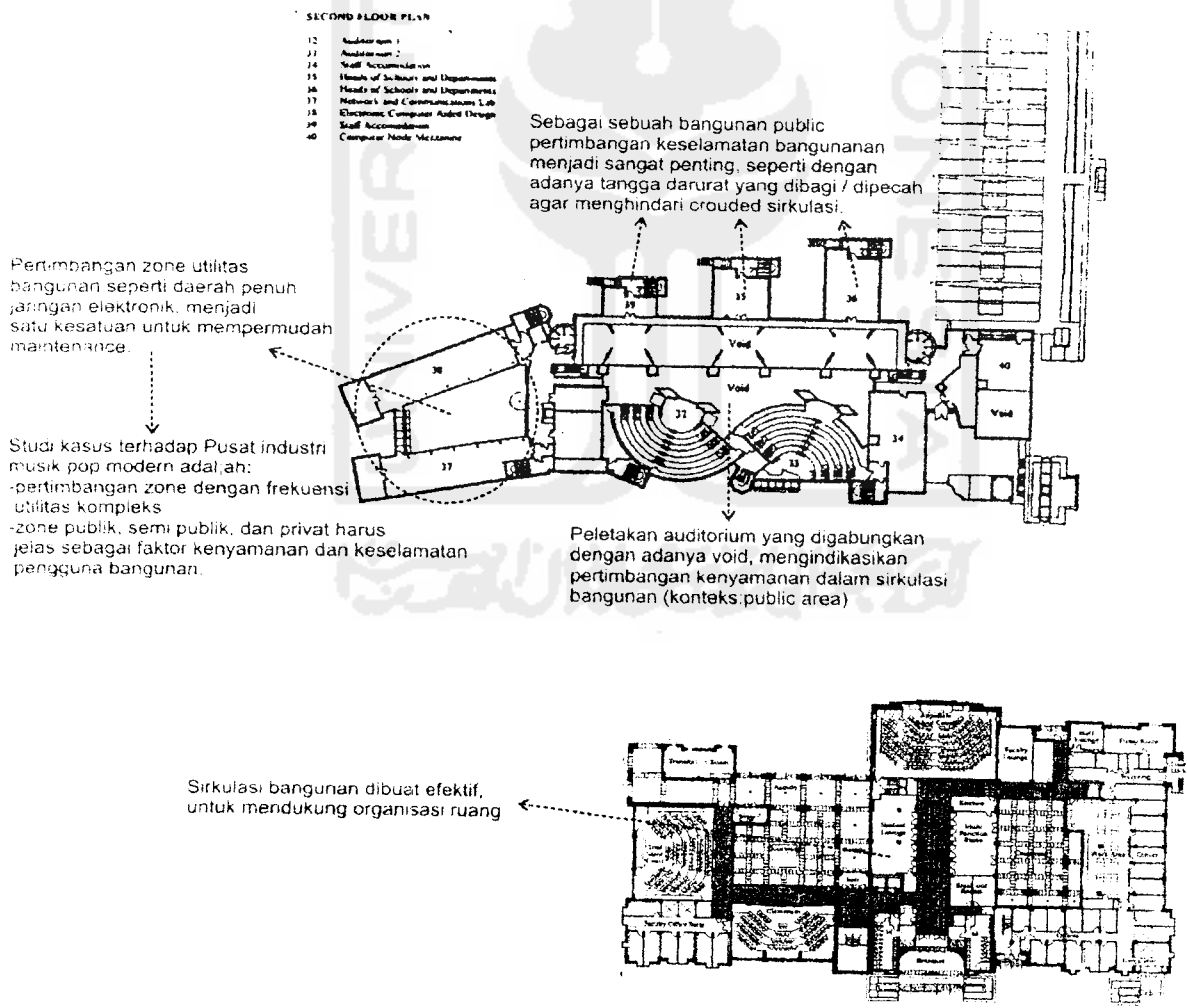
Studi kasus denah lantai atas Stage Theater Washington DC
